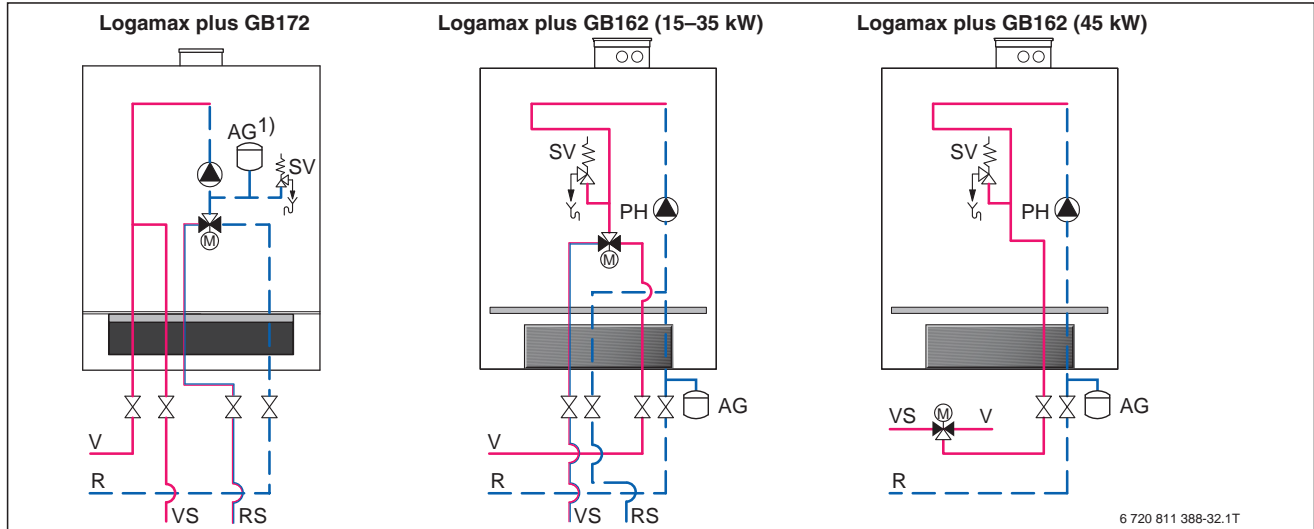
Detailhydraulik für Gas-Brennwertgeräte bei Anlagenbeispielen zur solaren Warmwasserbereitung
